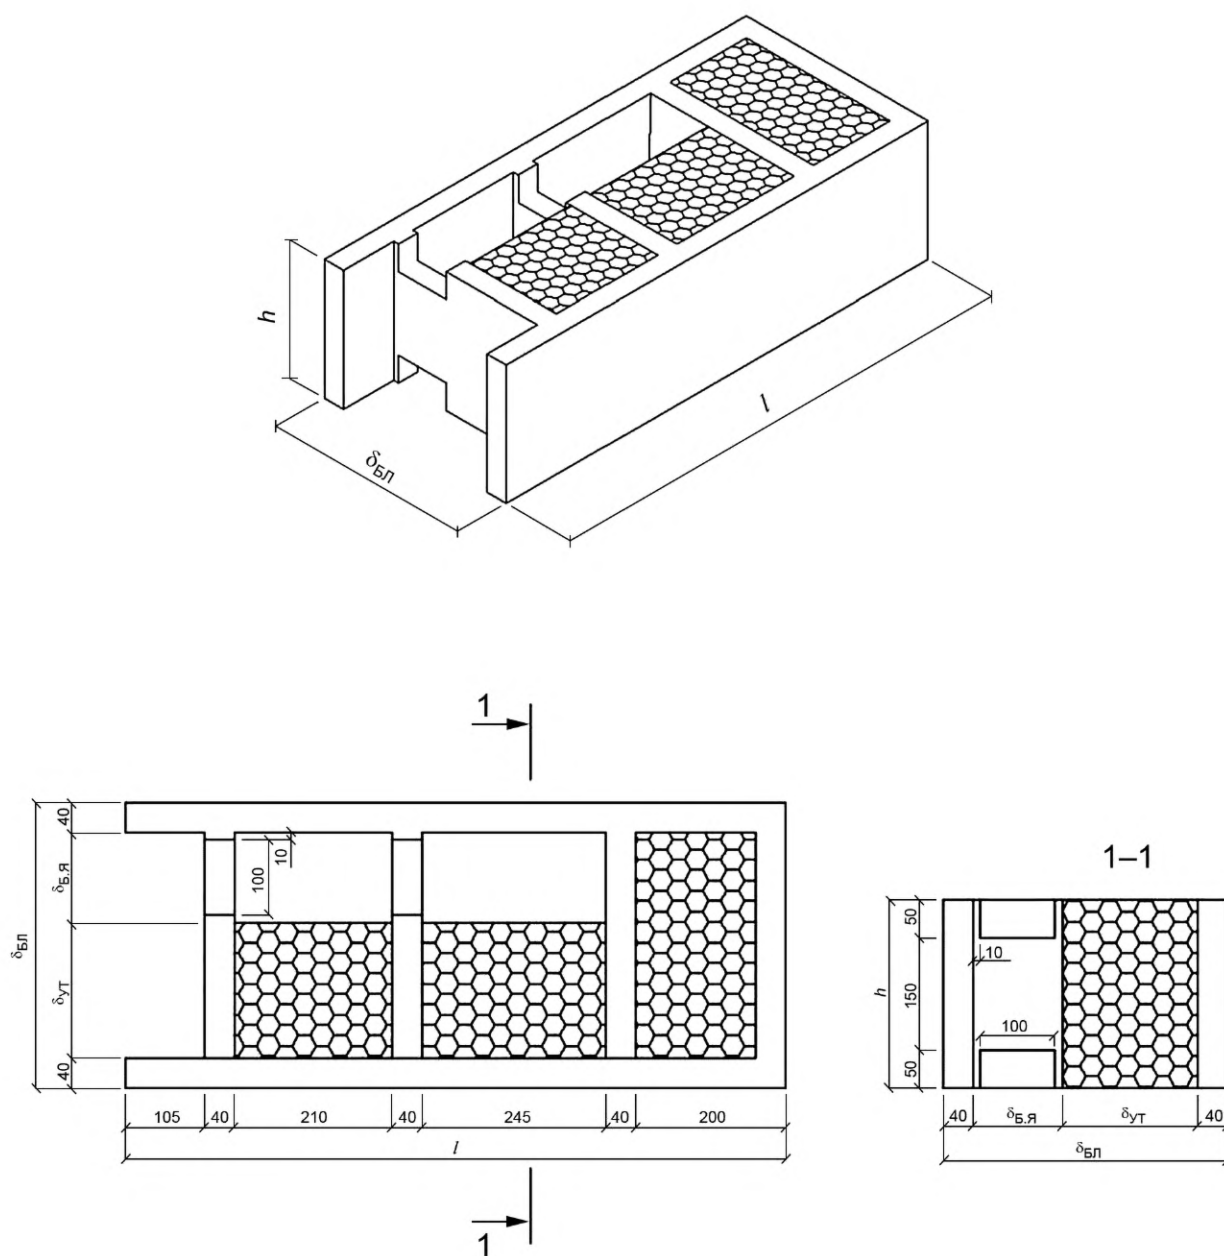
Блок наружной стены угловой утепленный (НС-УГ-УТ-38/15)
